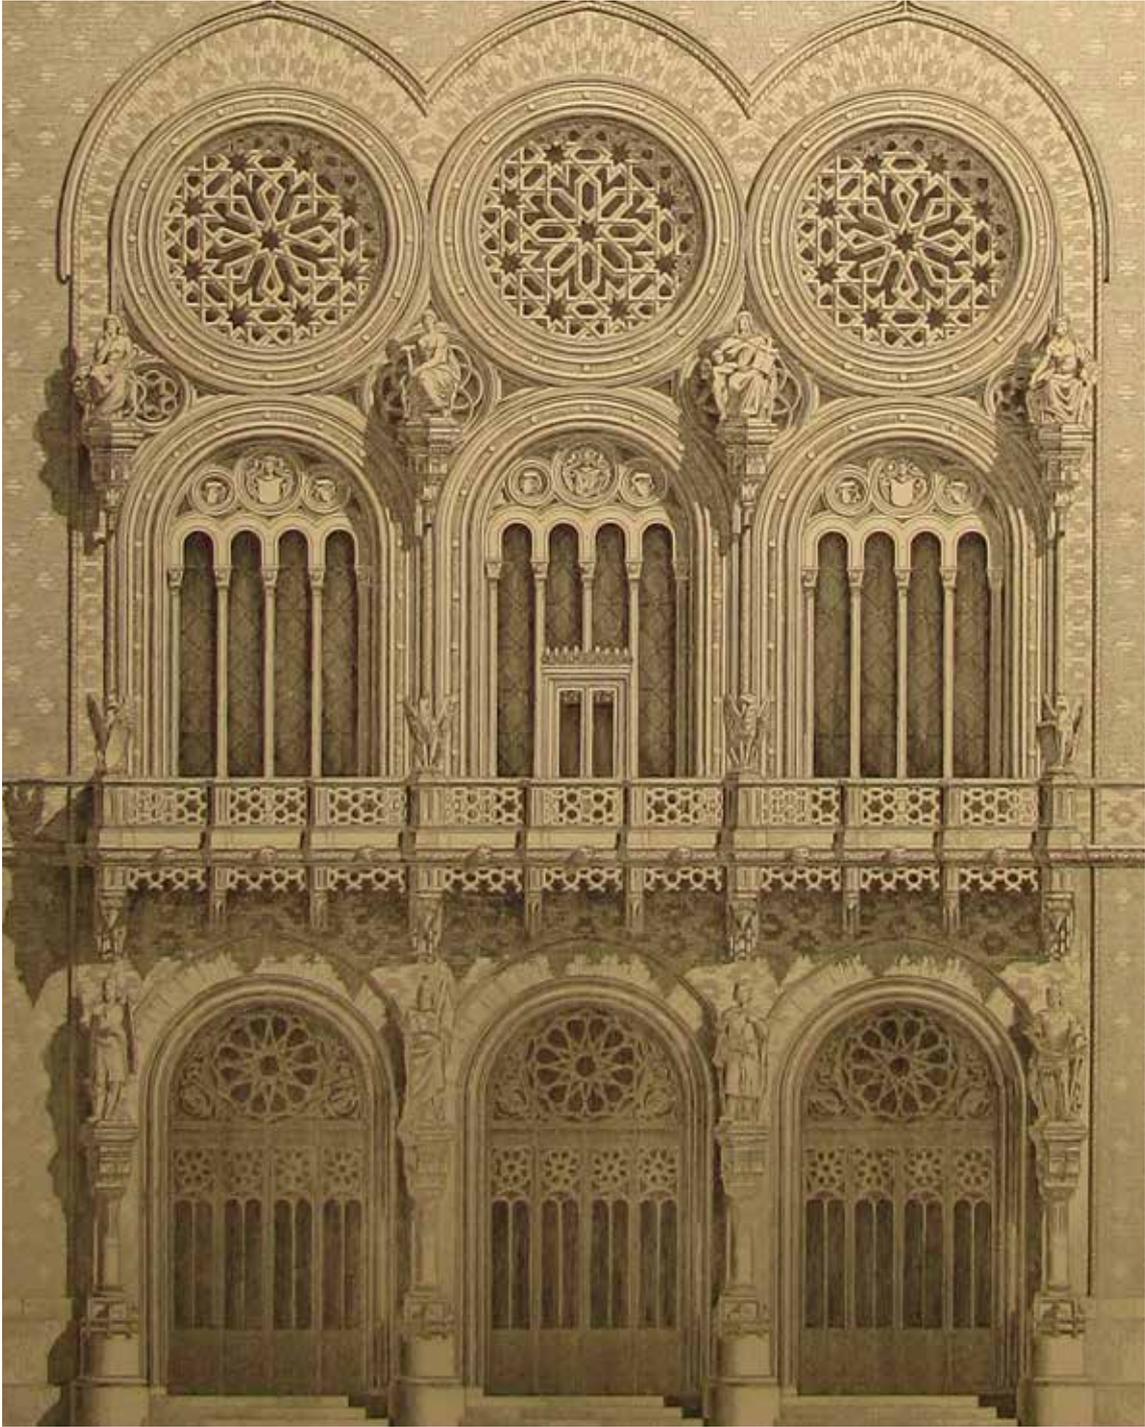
, Fassadenaufriss des Waffenmuseums, Ausschnitt,
